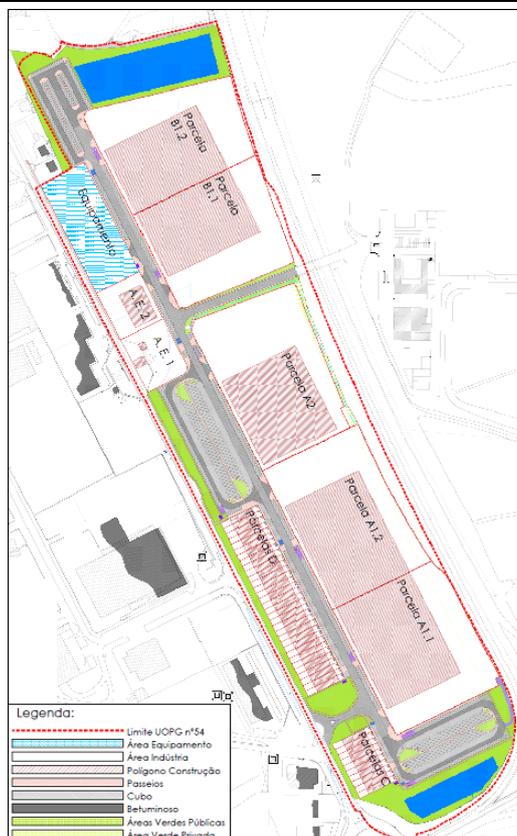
Planta de cenário da intervenção proposta (sem escala)
